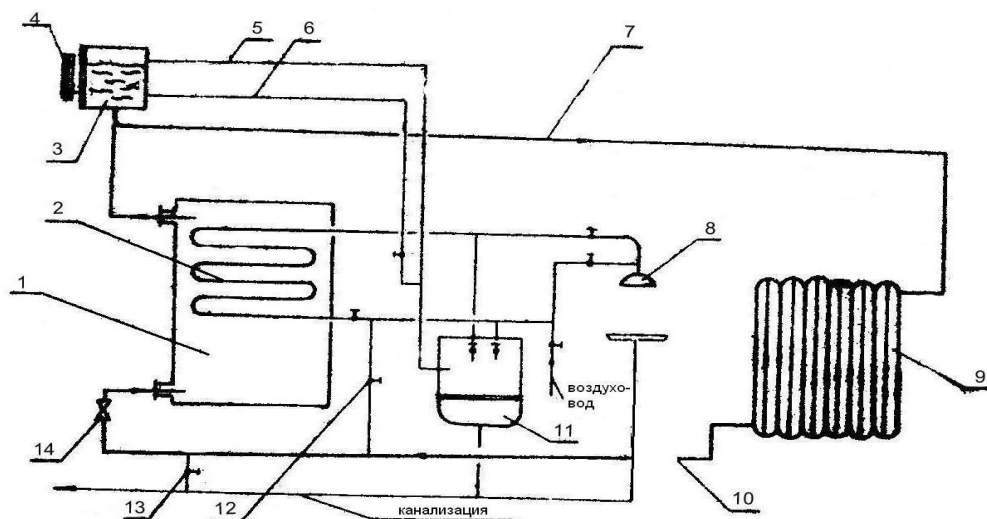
Схема отопления и горячего водоснабжения жилого дома: 1— котел; 2—теплообменник горячего водоснабжения; 3—расширительный бак; 4—уровень; 5—переливная линия; 6— контрольный трубопровод; 7—прямой
